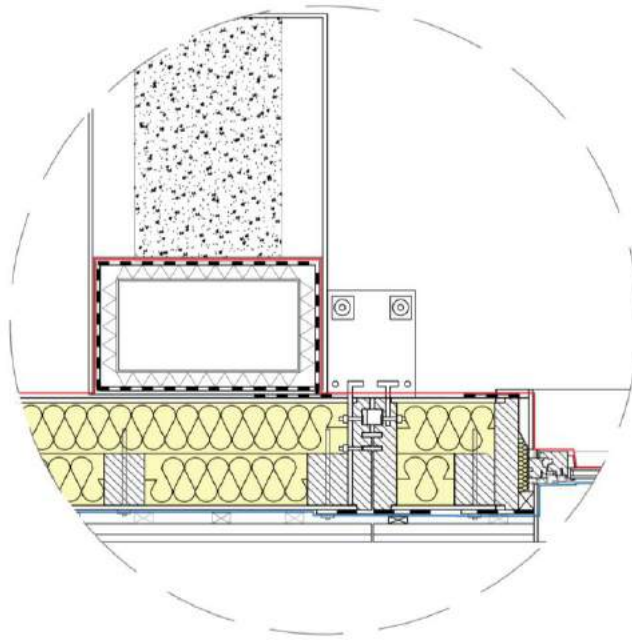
Plan avec la ventilation et l'attache des modules à la dalle.
